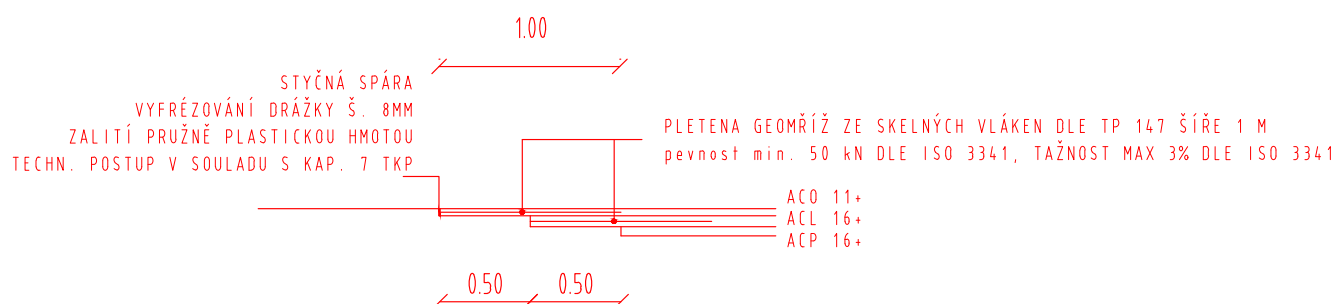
DETAIL NAPOJENÍ KONSTRUKČNÍCH VRSTEV
